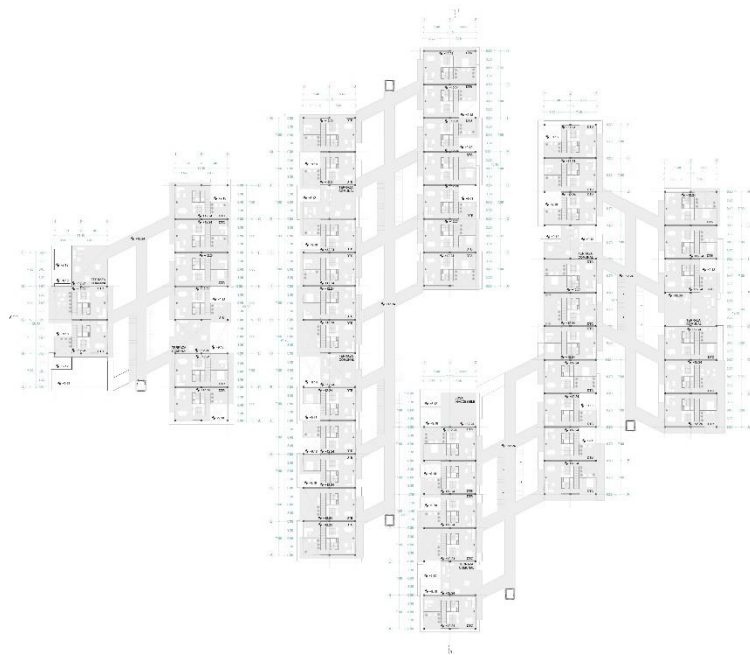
Planta nivel +3.06 (Cuito, 2017)
